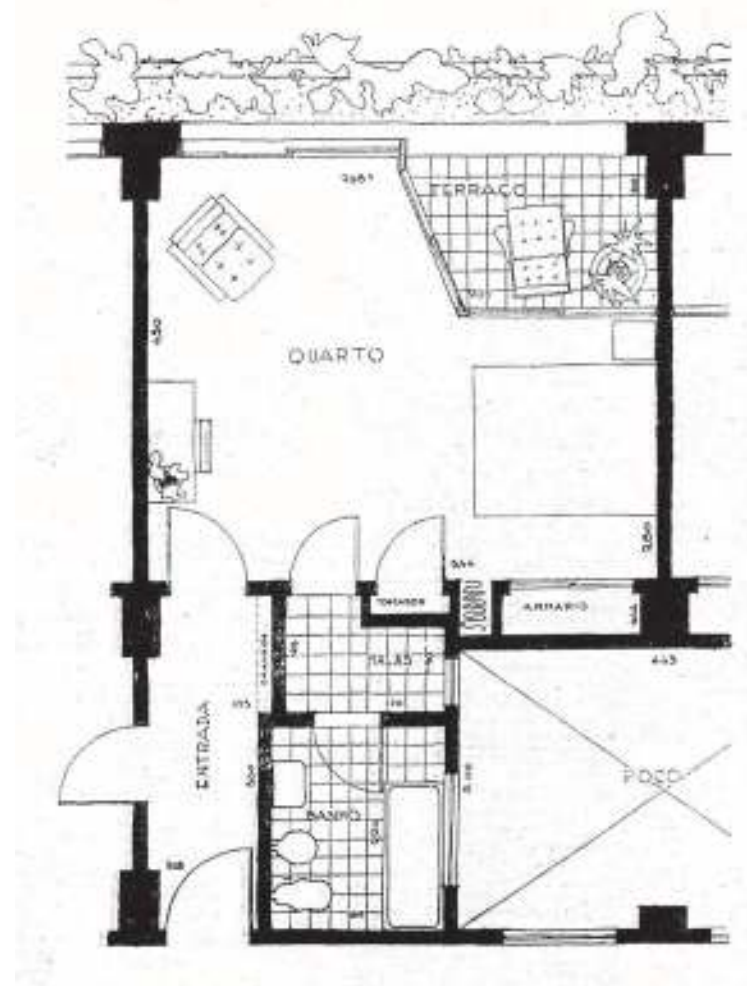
Planta de um dos apartamentos tipo, desenhada pelo arquiteto.
